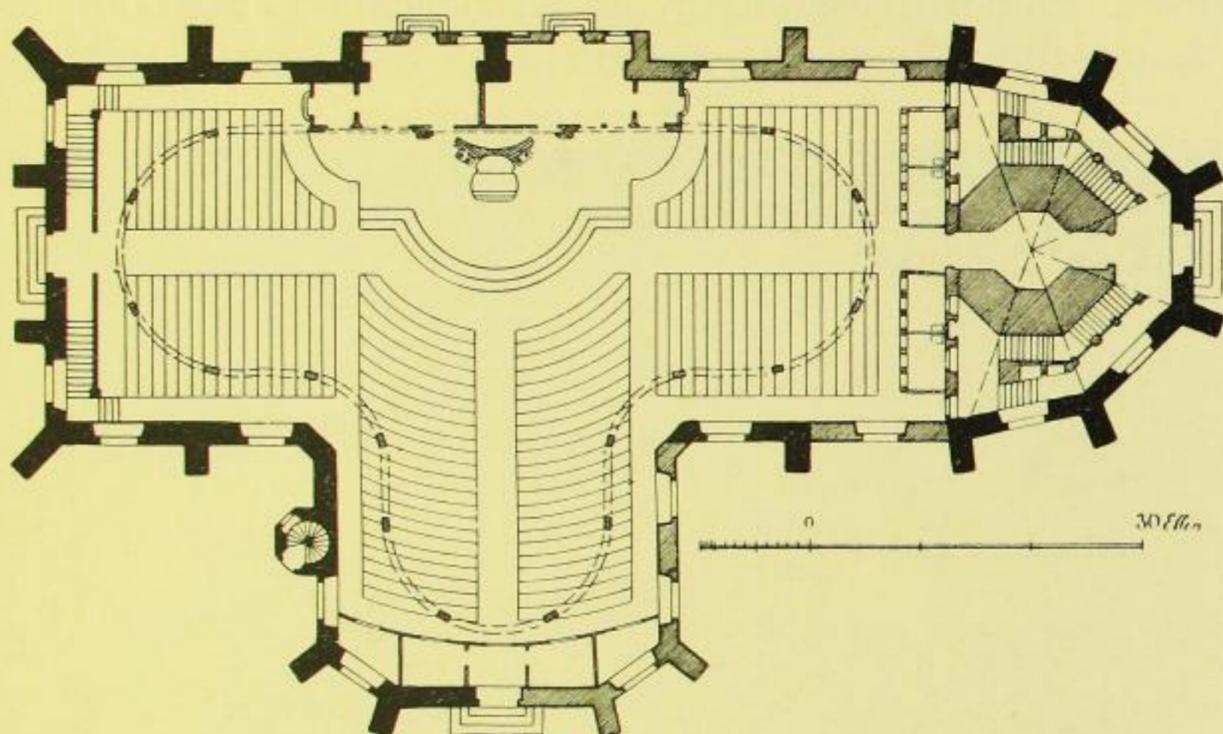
Marienkirche, Planung zum Grundriß des Erdgeschosses.
